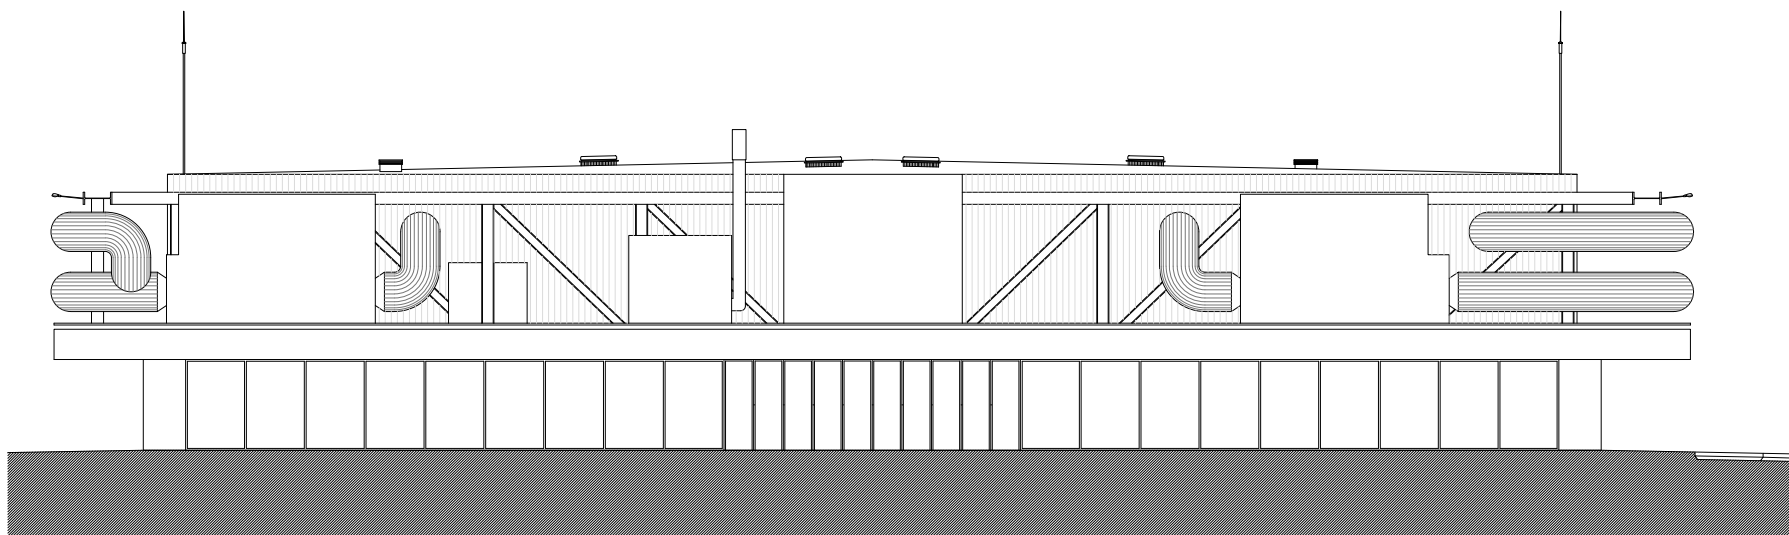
Alzado oeste do Centro Cultural. Escala 1/250.
